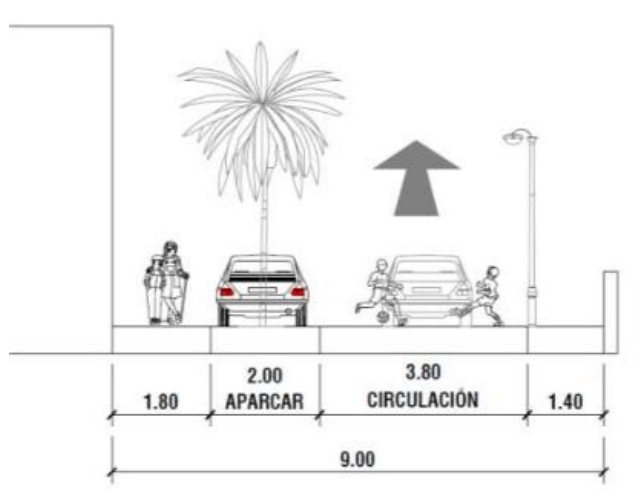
Sección Calle de Convivencia de 9 metros.
